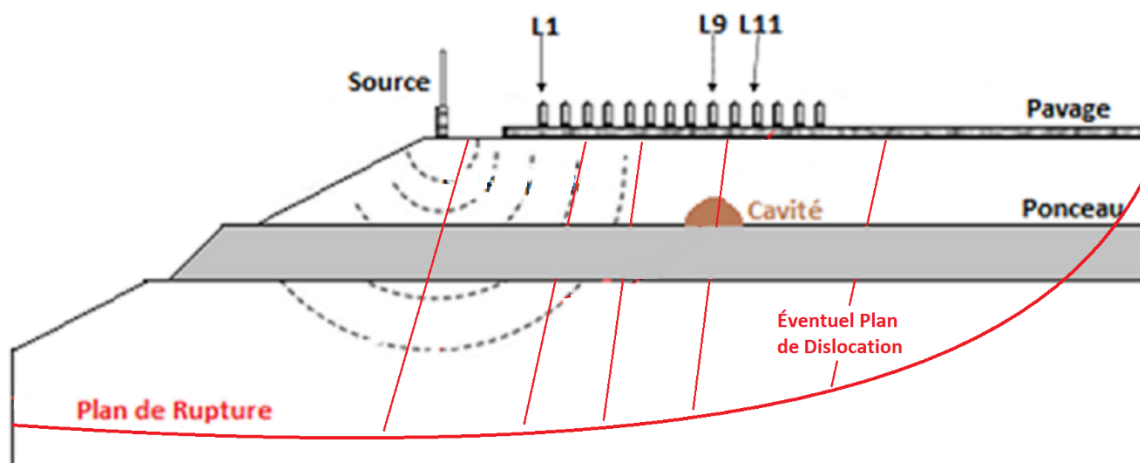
Schéma approximatif d'une coupe à travers la route suivant l'axe du ponceau montrant la position possible du plan de rupture en profondeur et des éventuels plans de dislocation. La position des lignes est visible par rapport aux fissures sur la figure 9.2.
